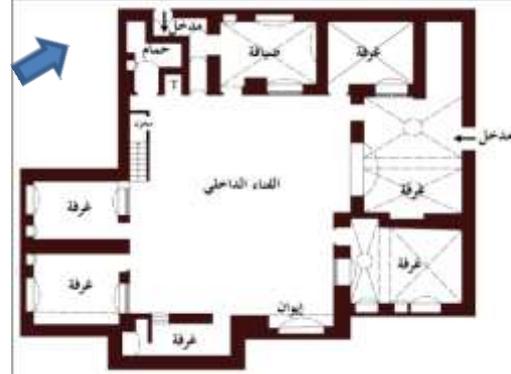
مسقط أفقي للبيت الأثري الطيني
